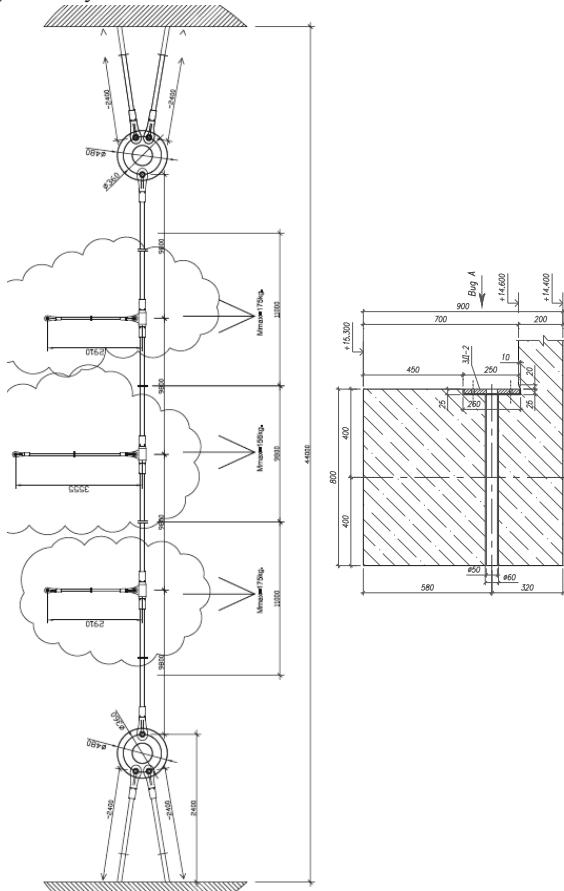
Конструкція попередньо натягнутої затяжки а) загальний вид; б) схема кріплення до залізобетонного покриття
